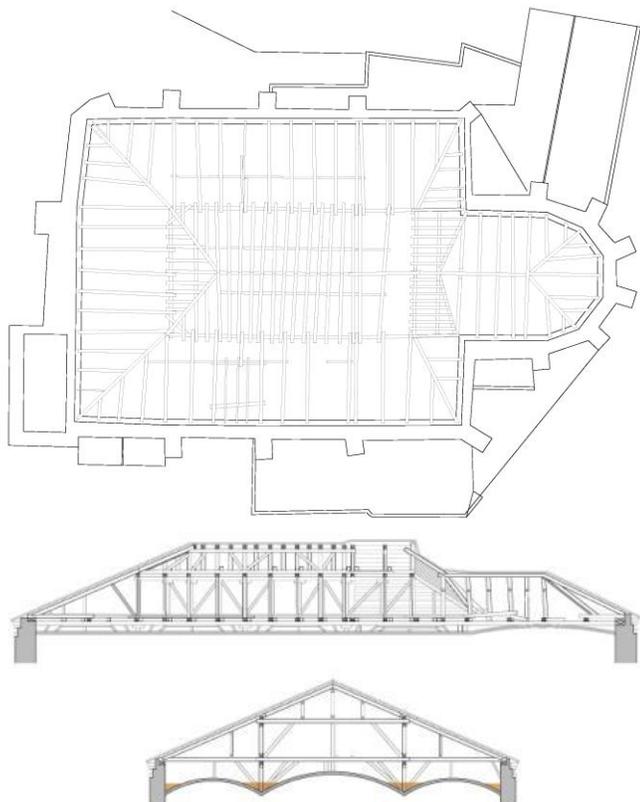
Colegiata de Roa. Estado inicial. Planta de la estructura de las cubiertas, sección longitudinal por nave central y sección transversal
